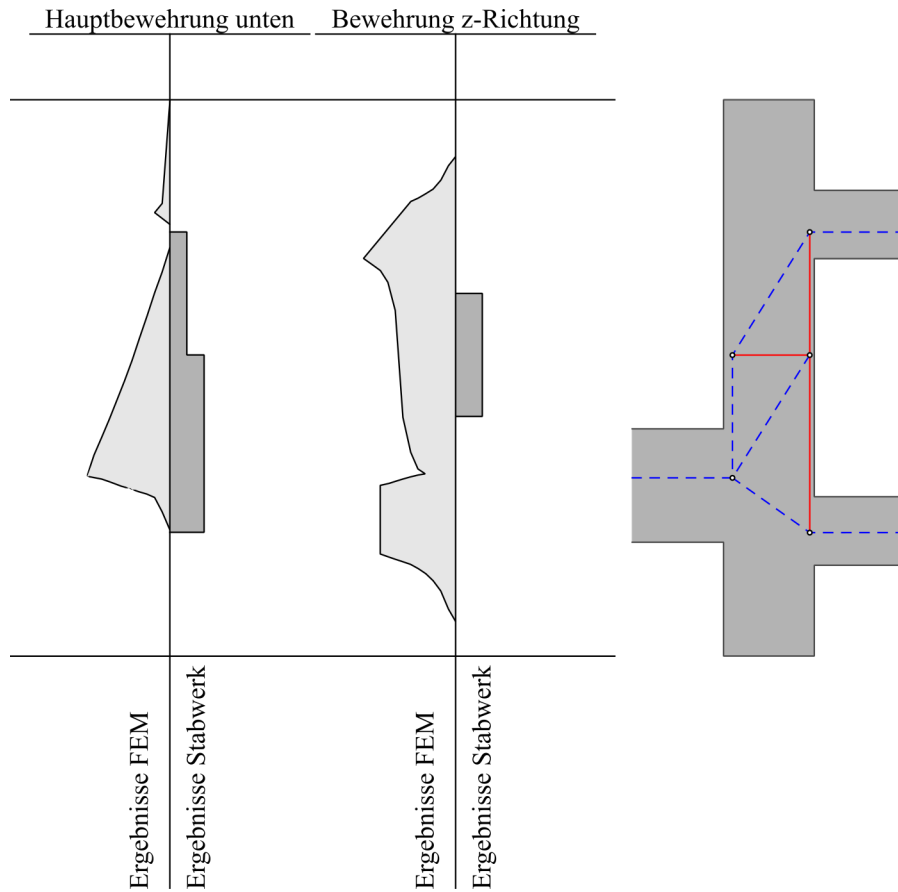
Variante 1 Lastfall 1 - Bewehrungsvergleich
